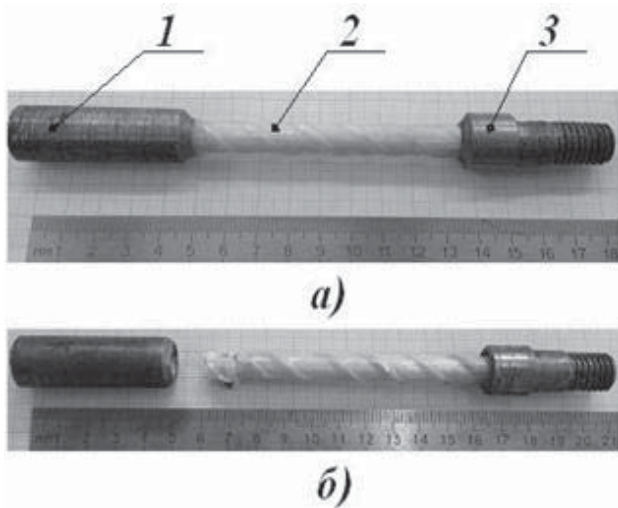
Образец для исследования на усталость: а) до разрушения; 1 – головка под захват машины; 2 – исследуемый пруток; 3 – головка под подшипники с серьгой для гирь; б) после разрушения
